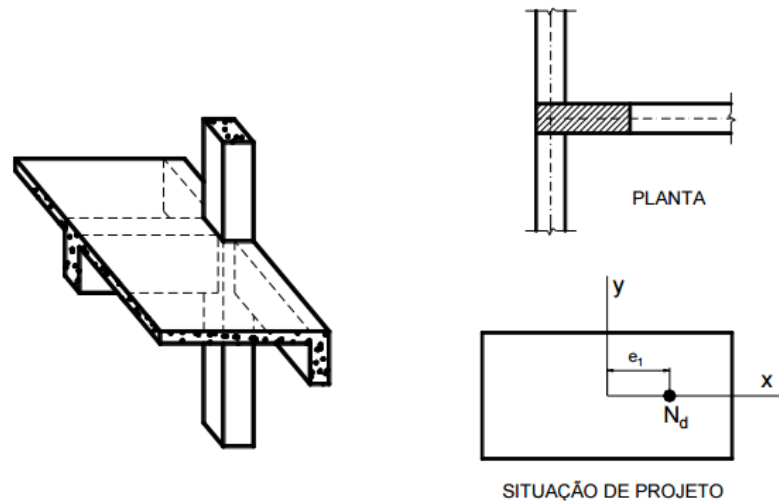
Arranjo estrutural e situação de projeto dos pilares intermediários
